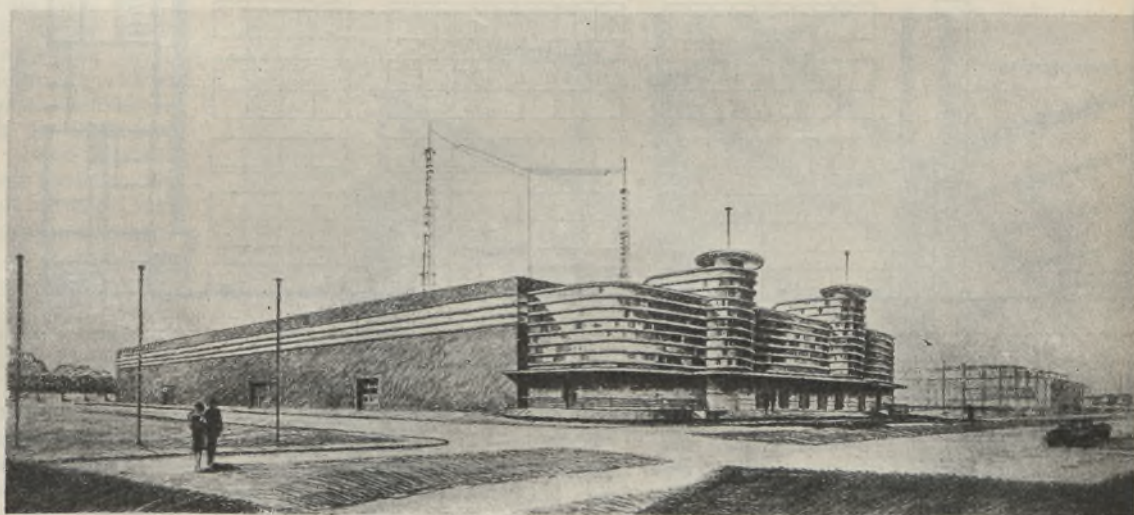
Entwurf Kell & Löser mit Wolf Netter & Jakobi, Abt. Eisenbau Schiege, Architekten Crämer & Petschler, Leipzig (vergl. Abb. 3).
